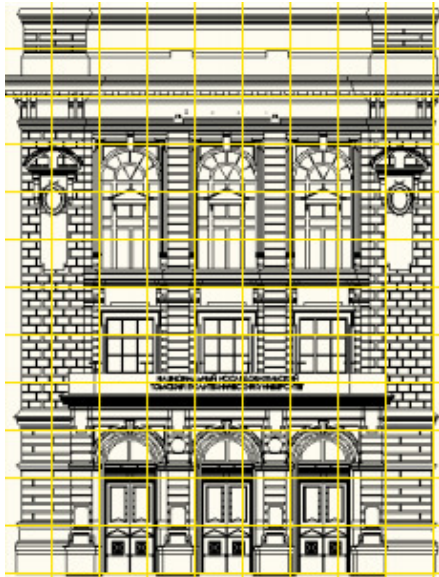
Чертёж фасада парадного входа в ГК ТПУ.
